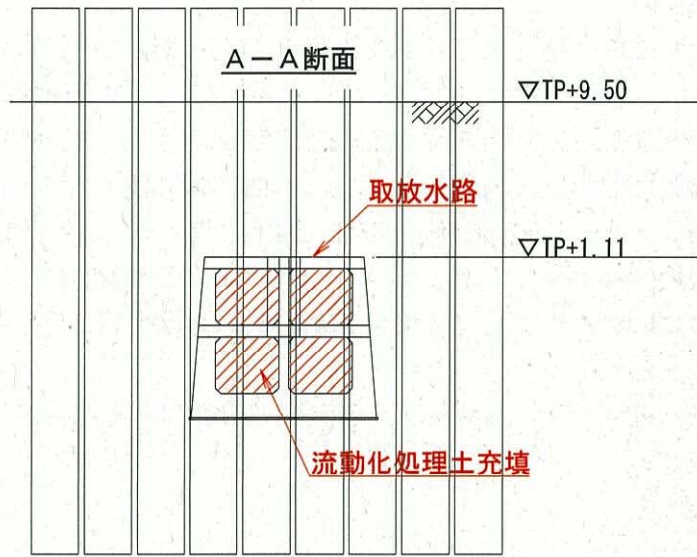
取放水路埋戻し位置断面図 (A-A 断面)
